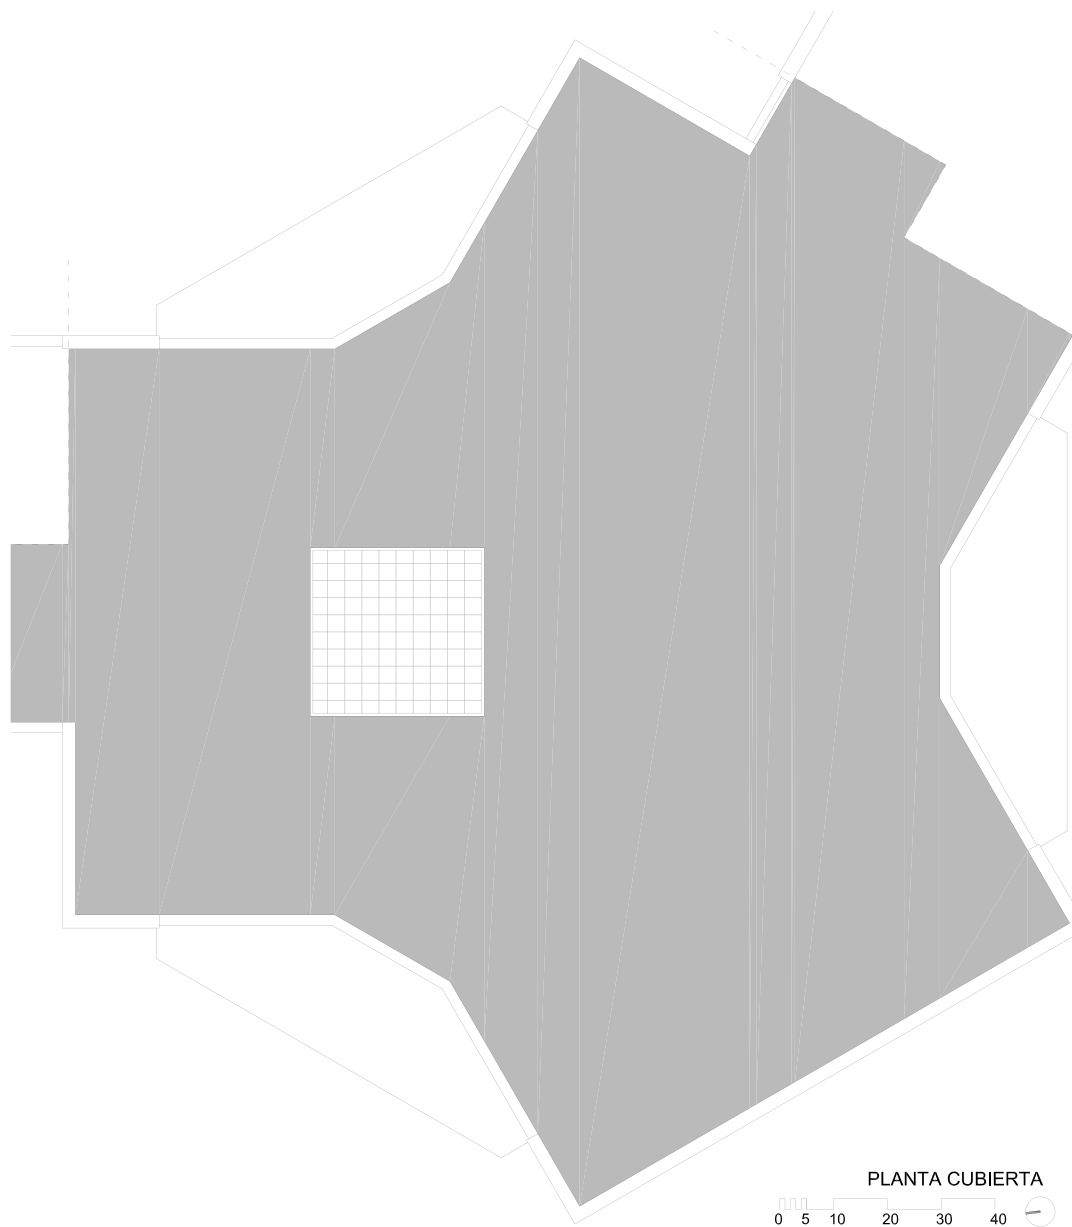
Planta de cubiertas realmente ejecutada de un módulo hexagonal del basamento. Elaboración propia en base a los planos de proyecto y la inspección del edificio contruido.
